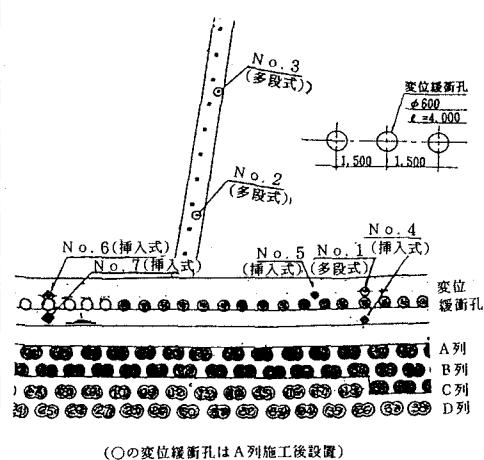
地盤柱状図 図-3 改良体配置および緩衝孔配置平面図
